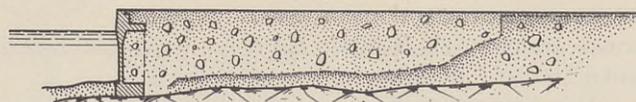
Eisenbetonkonstruktion in Blöcken, Stockholm, Norr Mälarstrand.
